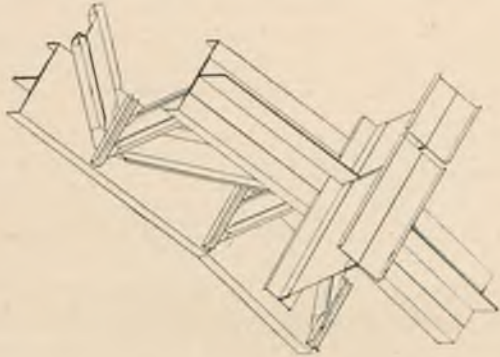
1/2 więzara dachowego. Widoczne są elementy skrzynkowe jako pokrycie dachowe.
